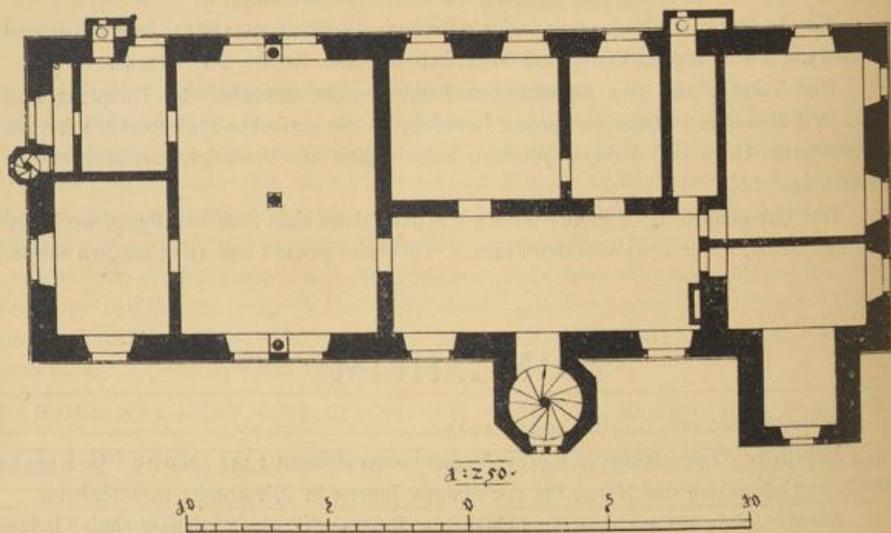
Rust. Schloss, Grundriss des Hauptgeschosses.
